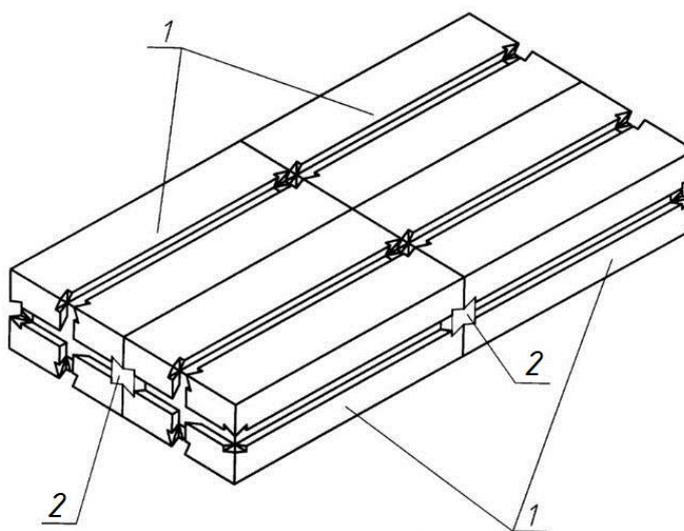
Общий вид сборной конструкции, выполненной из древоблоков: 1 – древоблоки; 2 – связевые элементы
